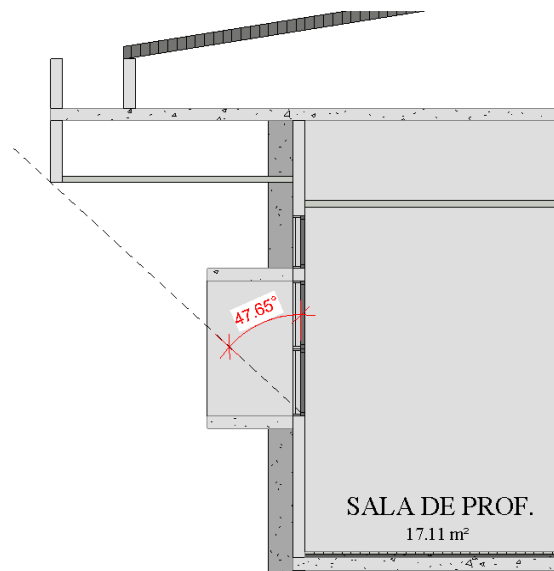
Ângulo vertical de sombreamento janela EA4 na fachada norte
